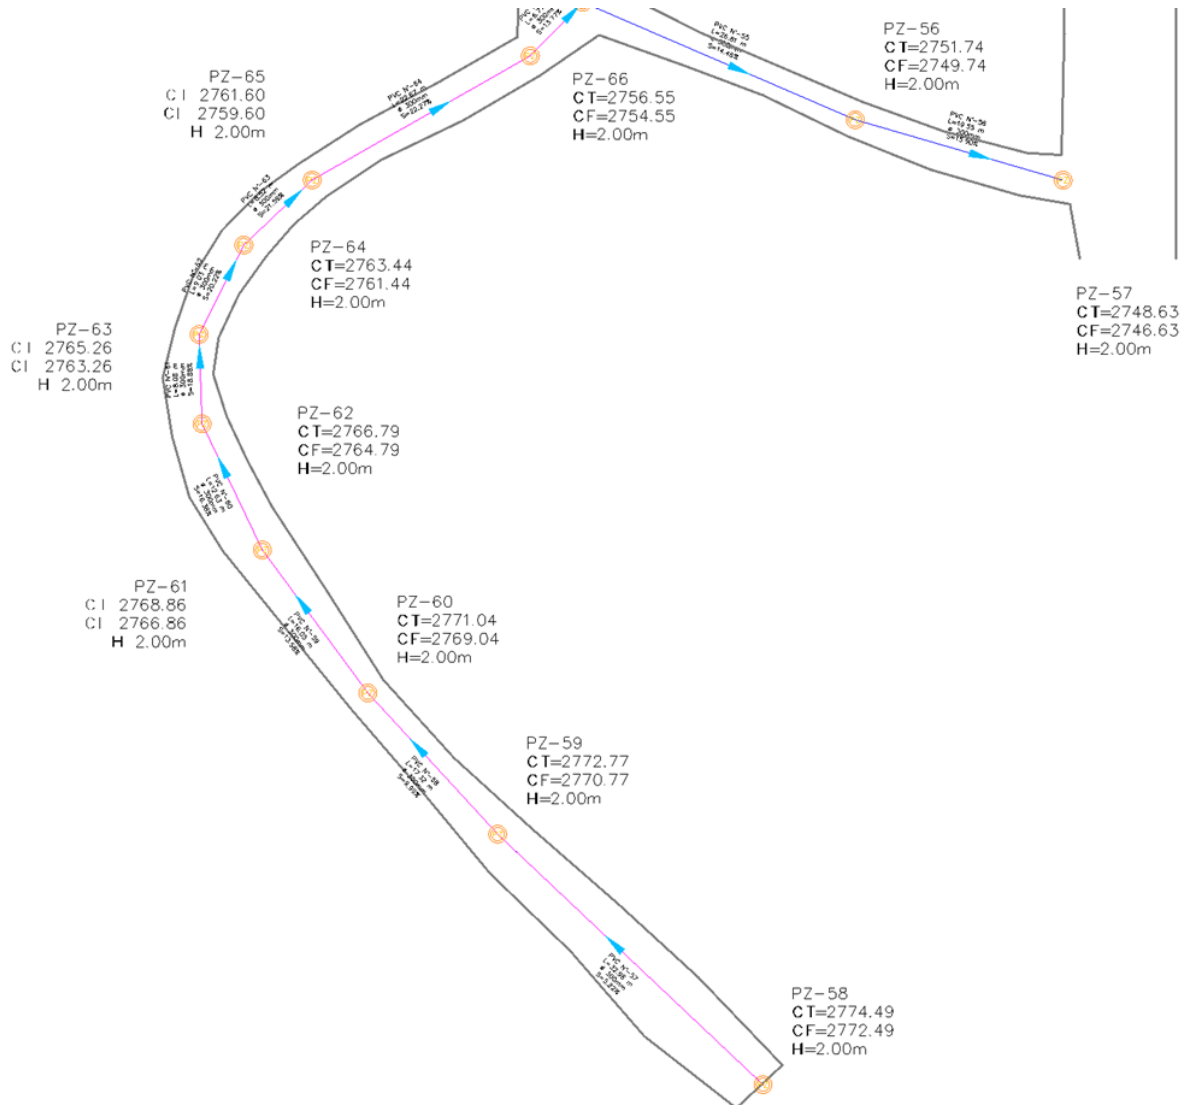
Distribución de red de alcantarillado calle 5. Elaboración: Autores
